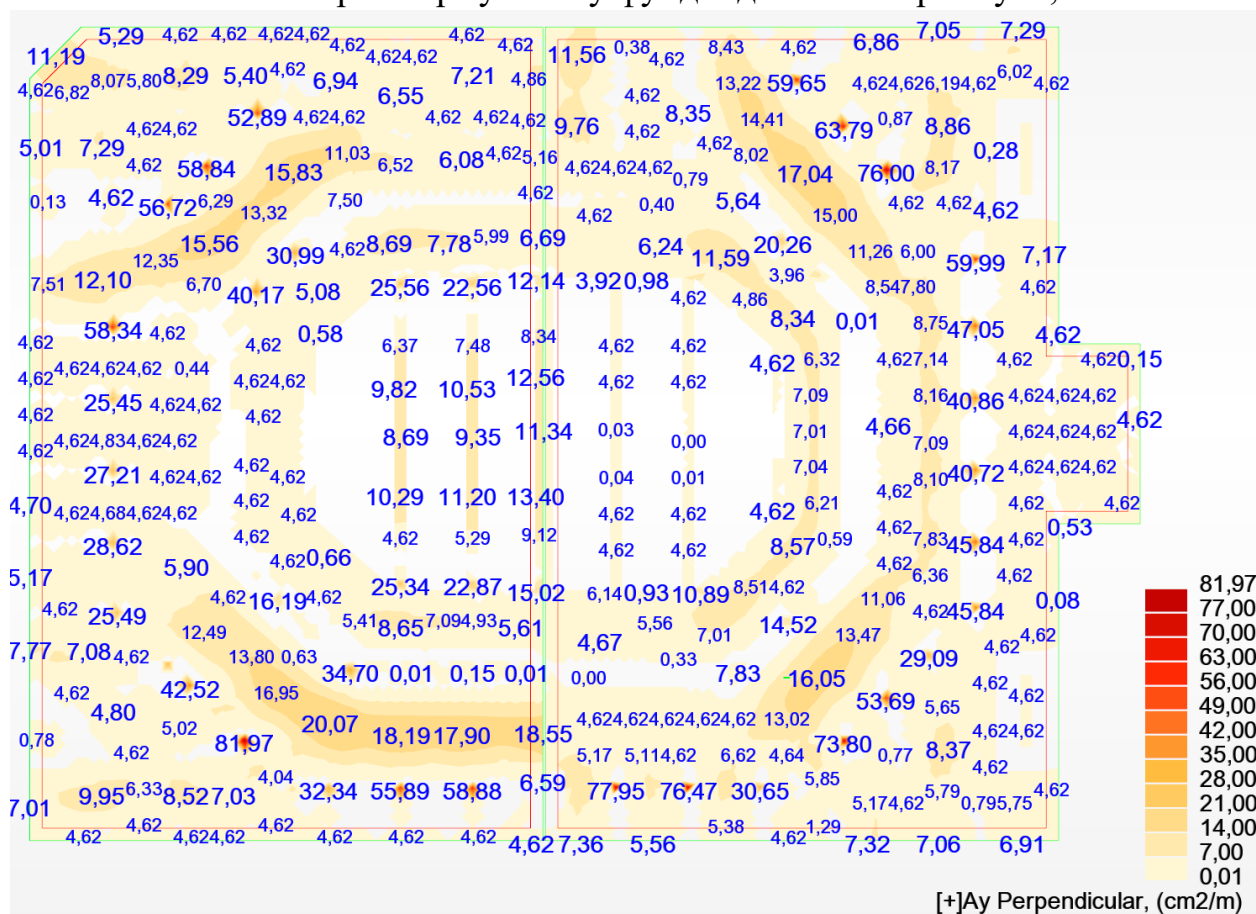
Верхнє армування фунд. плити по напрямку Y, см²/м
